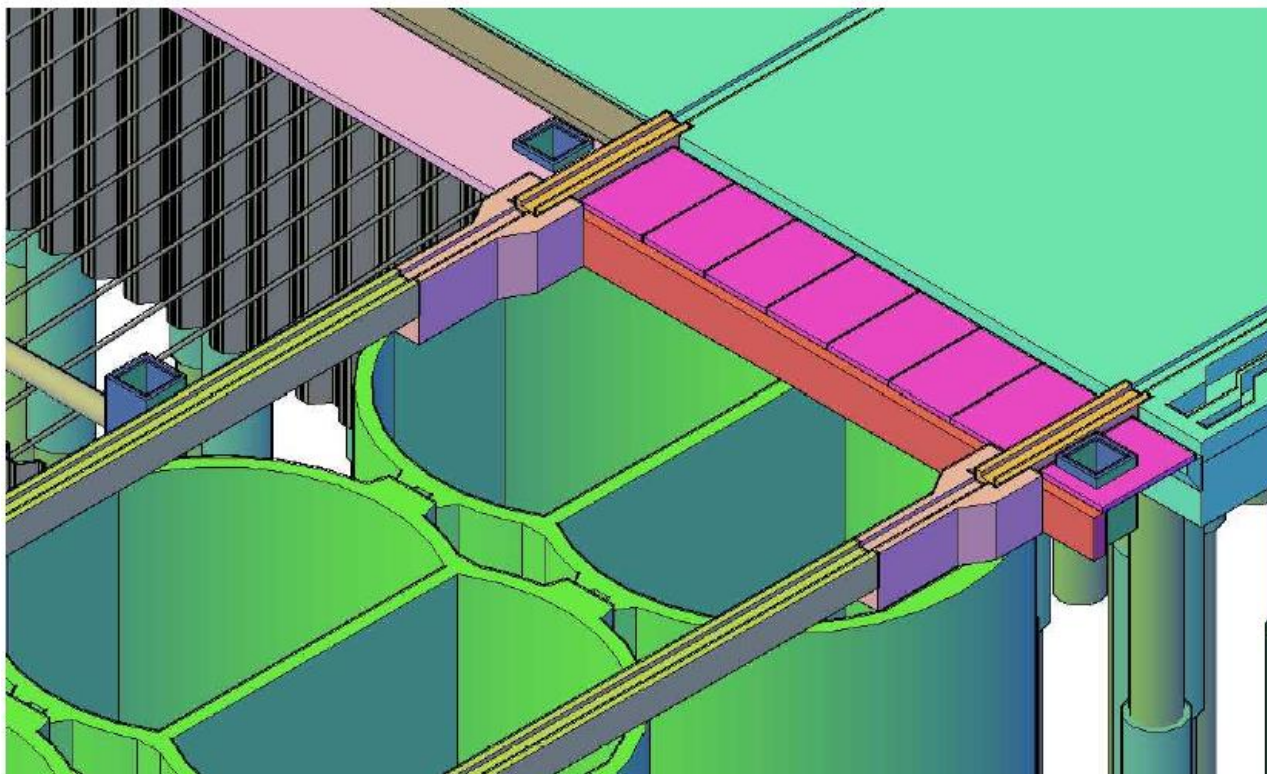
Pose des pré-dalles, dalle de transition et regards (Source : Egis Ports, 2021)
